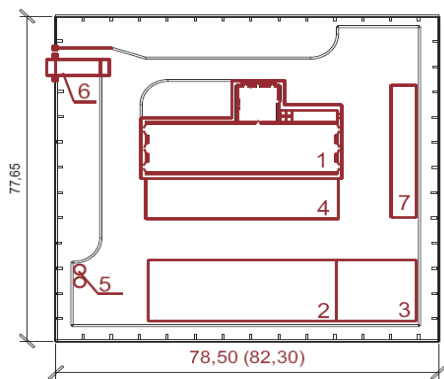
План семейной фермы по производству молока на 30-48 голов:
